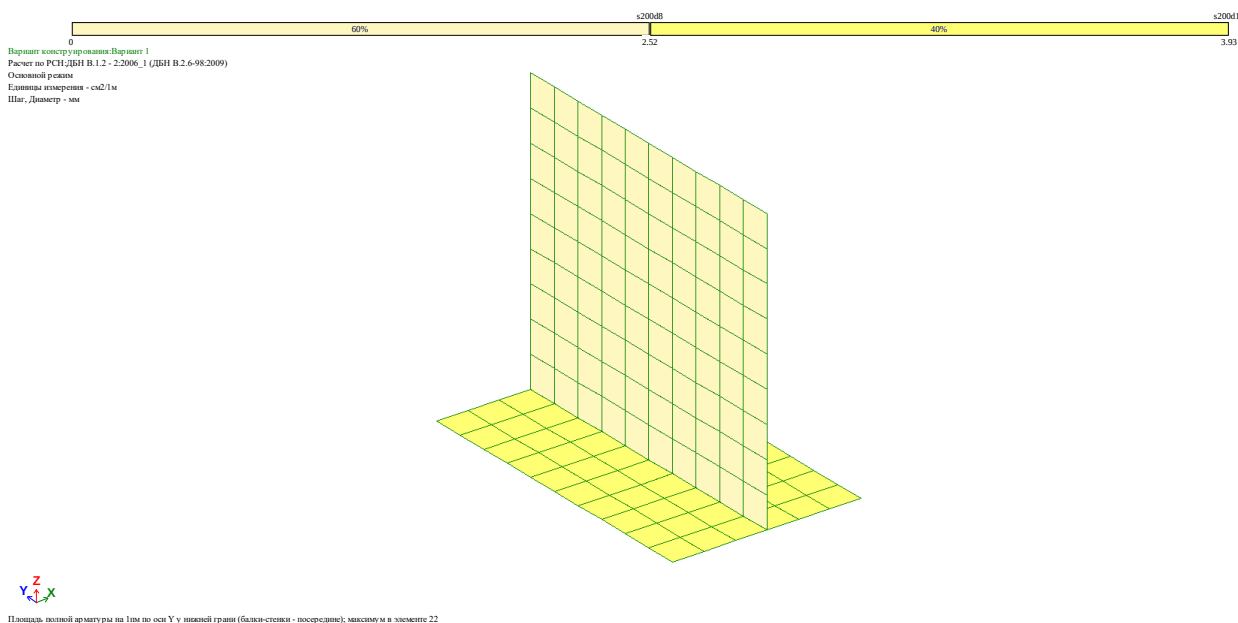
Площа армування вздовж осі Y по нижній грані
